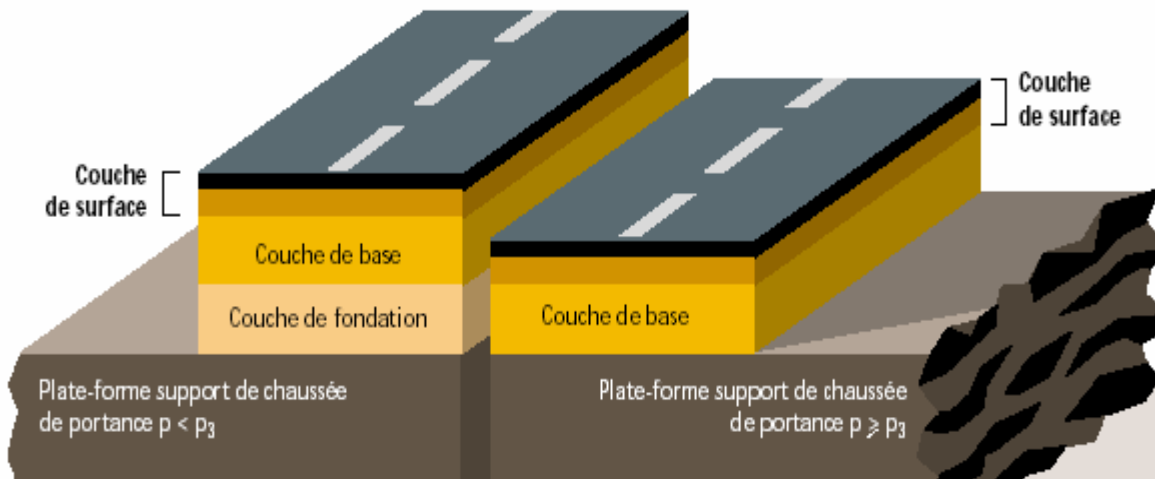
Le corps d'une chaussée semi rigide [06]
